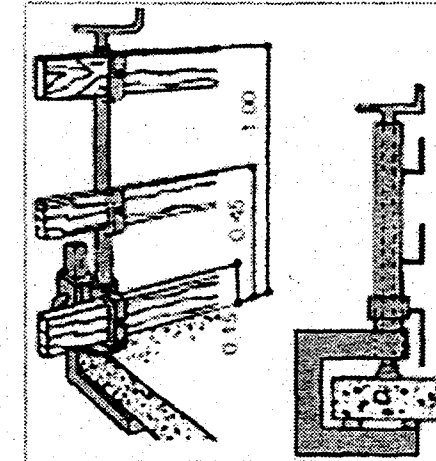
Dispositif de fixation par pincement de la dalle.
